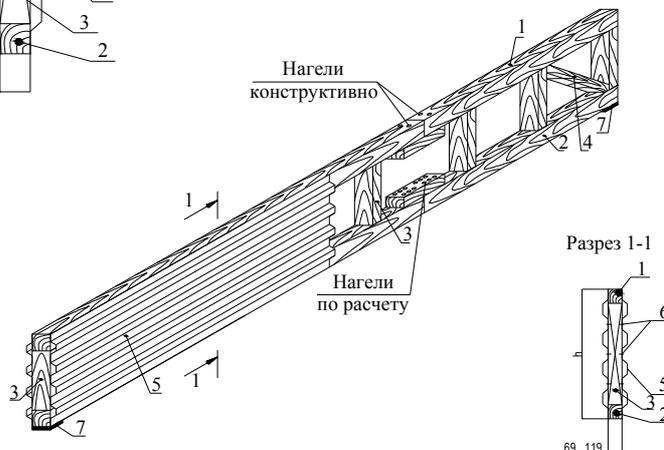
Деревометаллическая балка с тонкой профилированной стенкой пролетом 12м:
